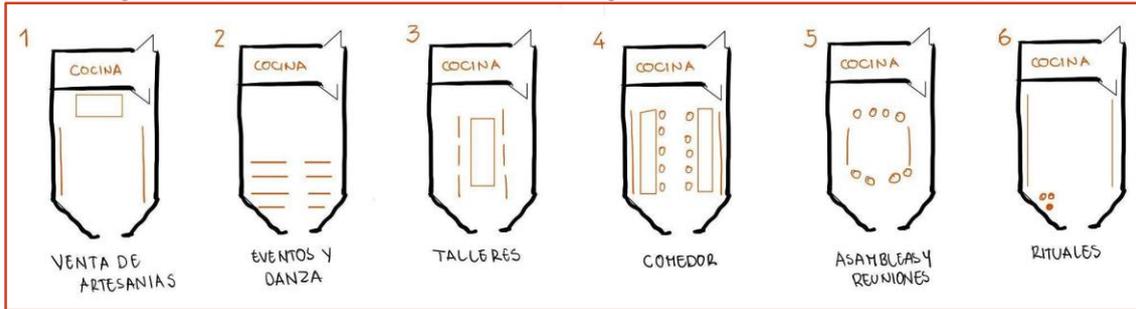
Esquema de planta arquitectónica del centro y multifuncionalidad. Fuente: Elaboración propia
